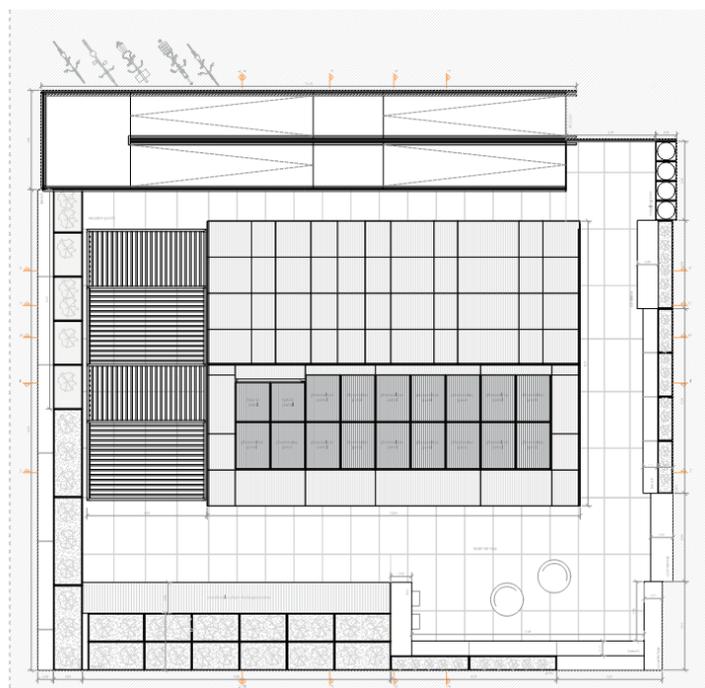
Planta de cubierta. Fuente: Azalea.
